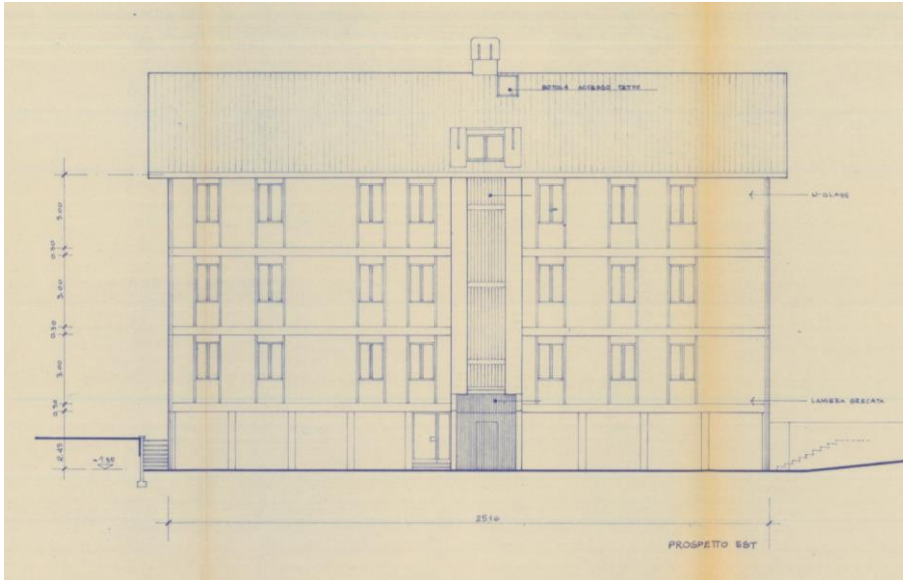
, Prospetto Nord-Est, scansione progetto originale
